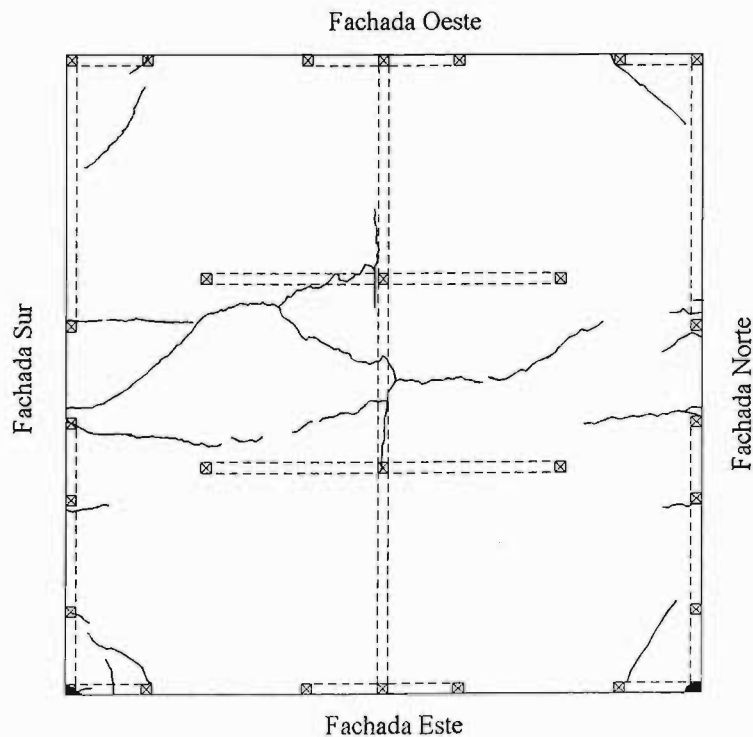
Agrietamiento de la losa al final del ensaye
